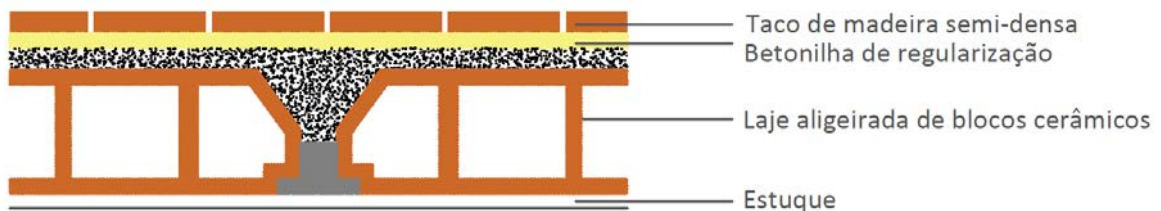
Solução construtiva tipo de pavimento sobre comércio/serviços – Pré intervenção
